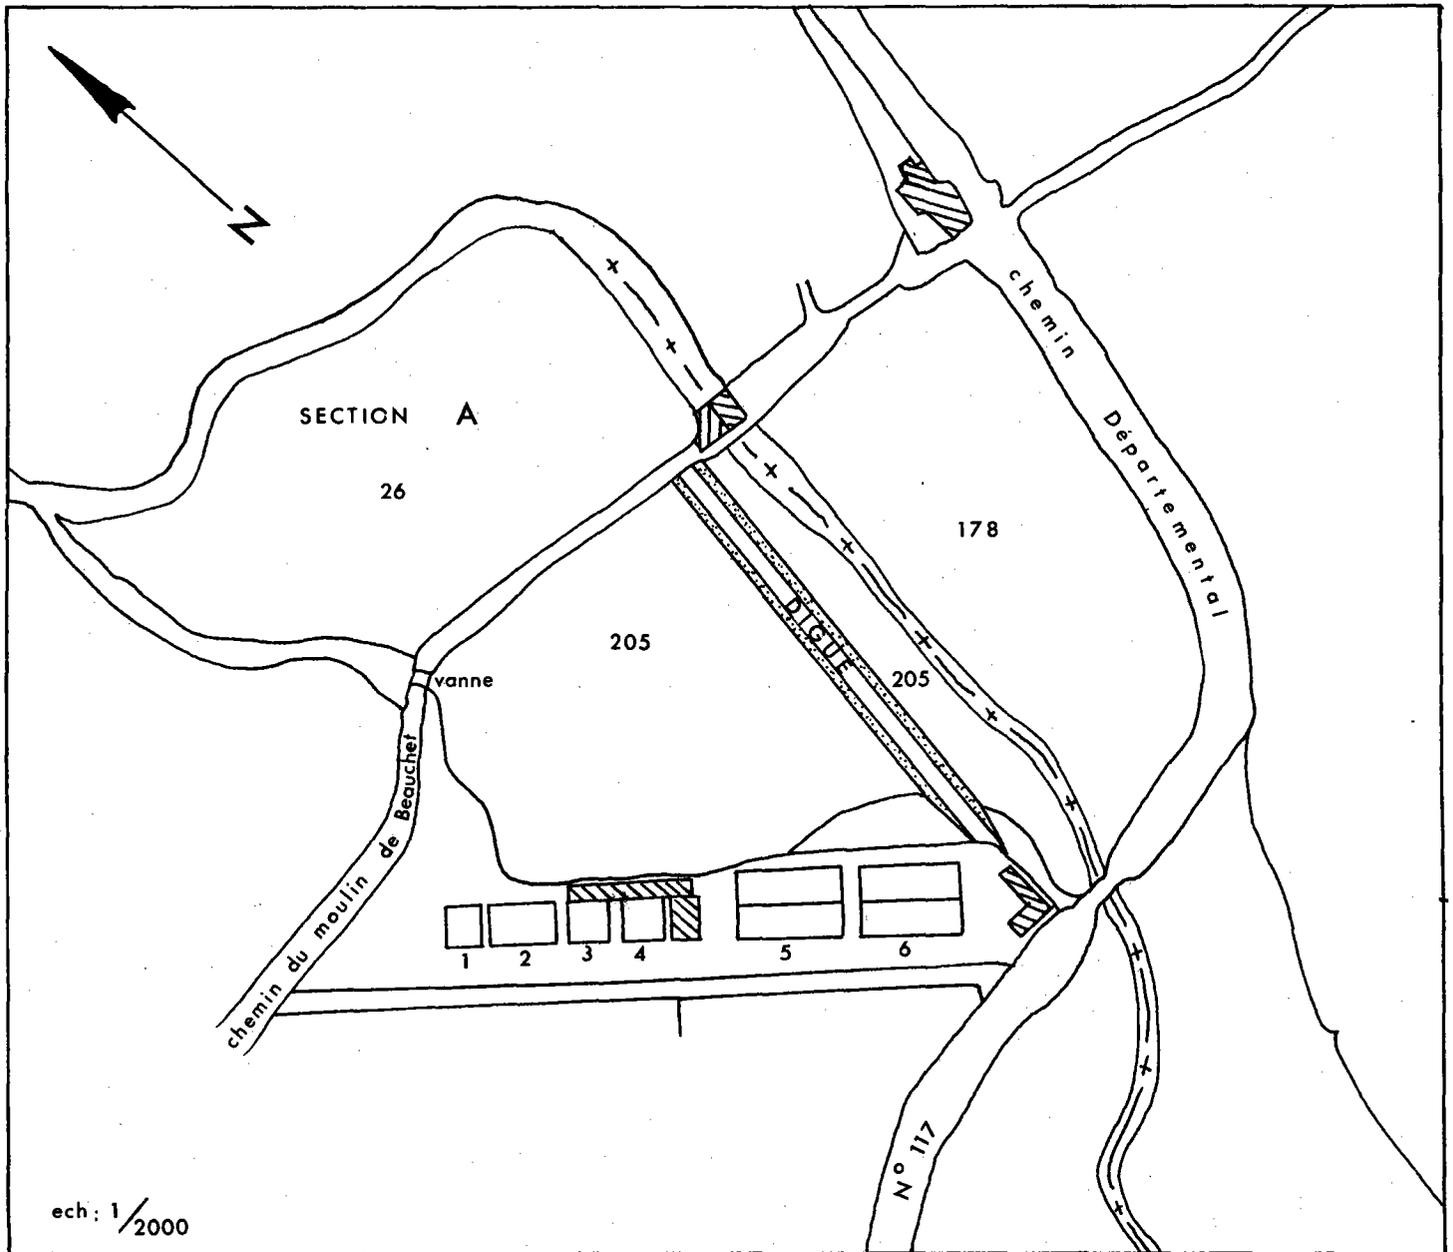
Plan du projet d'aménagement de l'étang de Beauchet.
